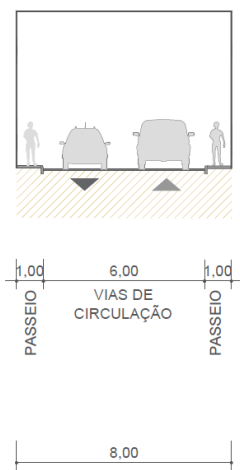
Secção tipo existente I – Túnel Rua Orfeão de Braga
